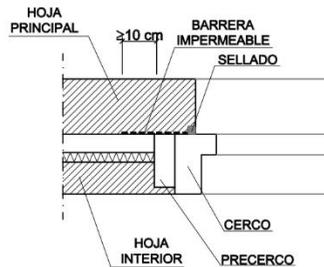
Ejemplo de encuentro de la fachada con la carpintería
